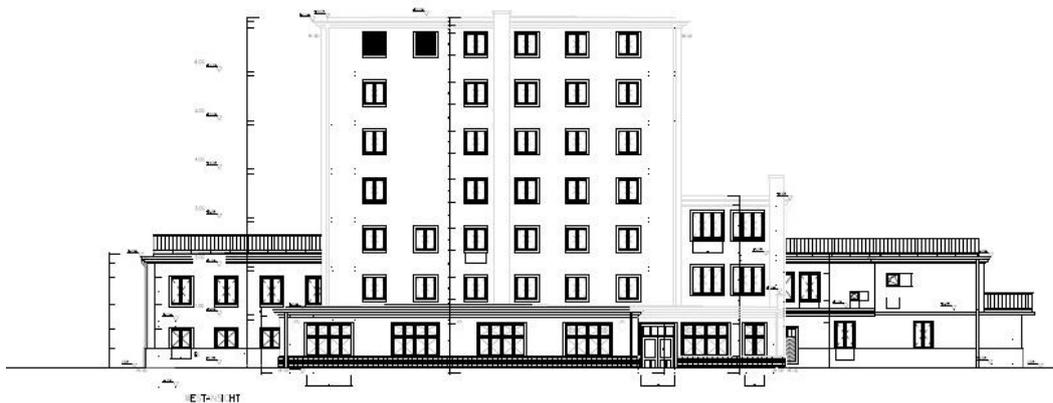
Teilansicht Pilotgebäude, Quelle: Campus Berlin Buch GmbH
